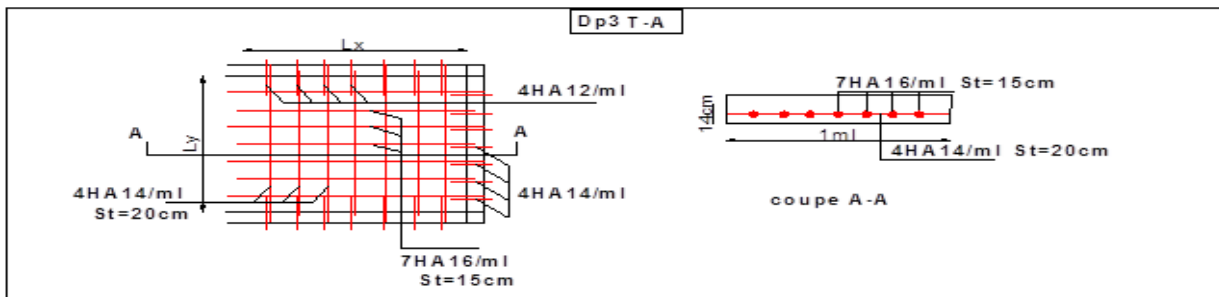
Schéma de ferrailage de D3 (T.inaccessible).
